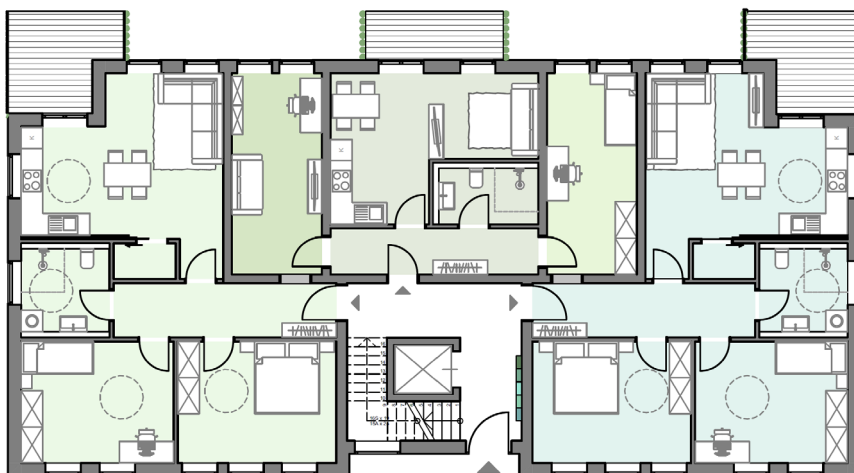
Grundriss flexibles Wohnen (eigene Darstellung)
